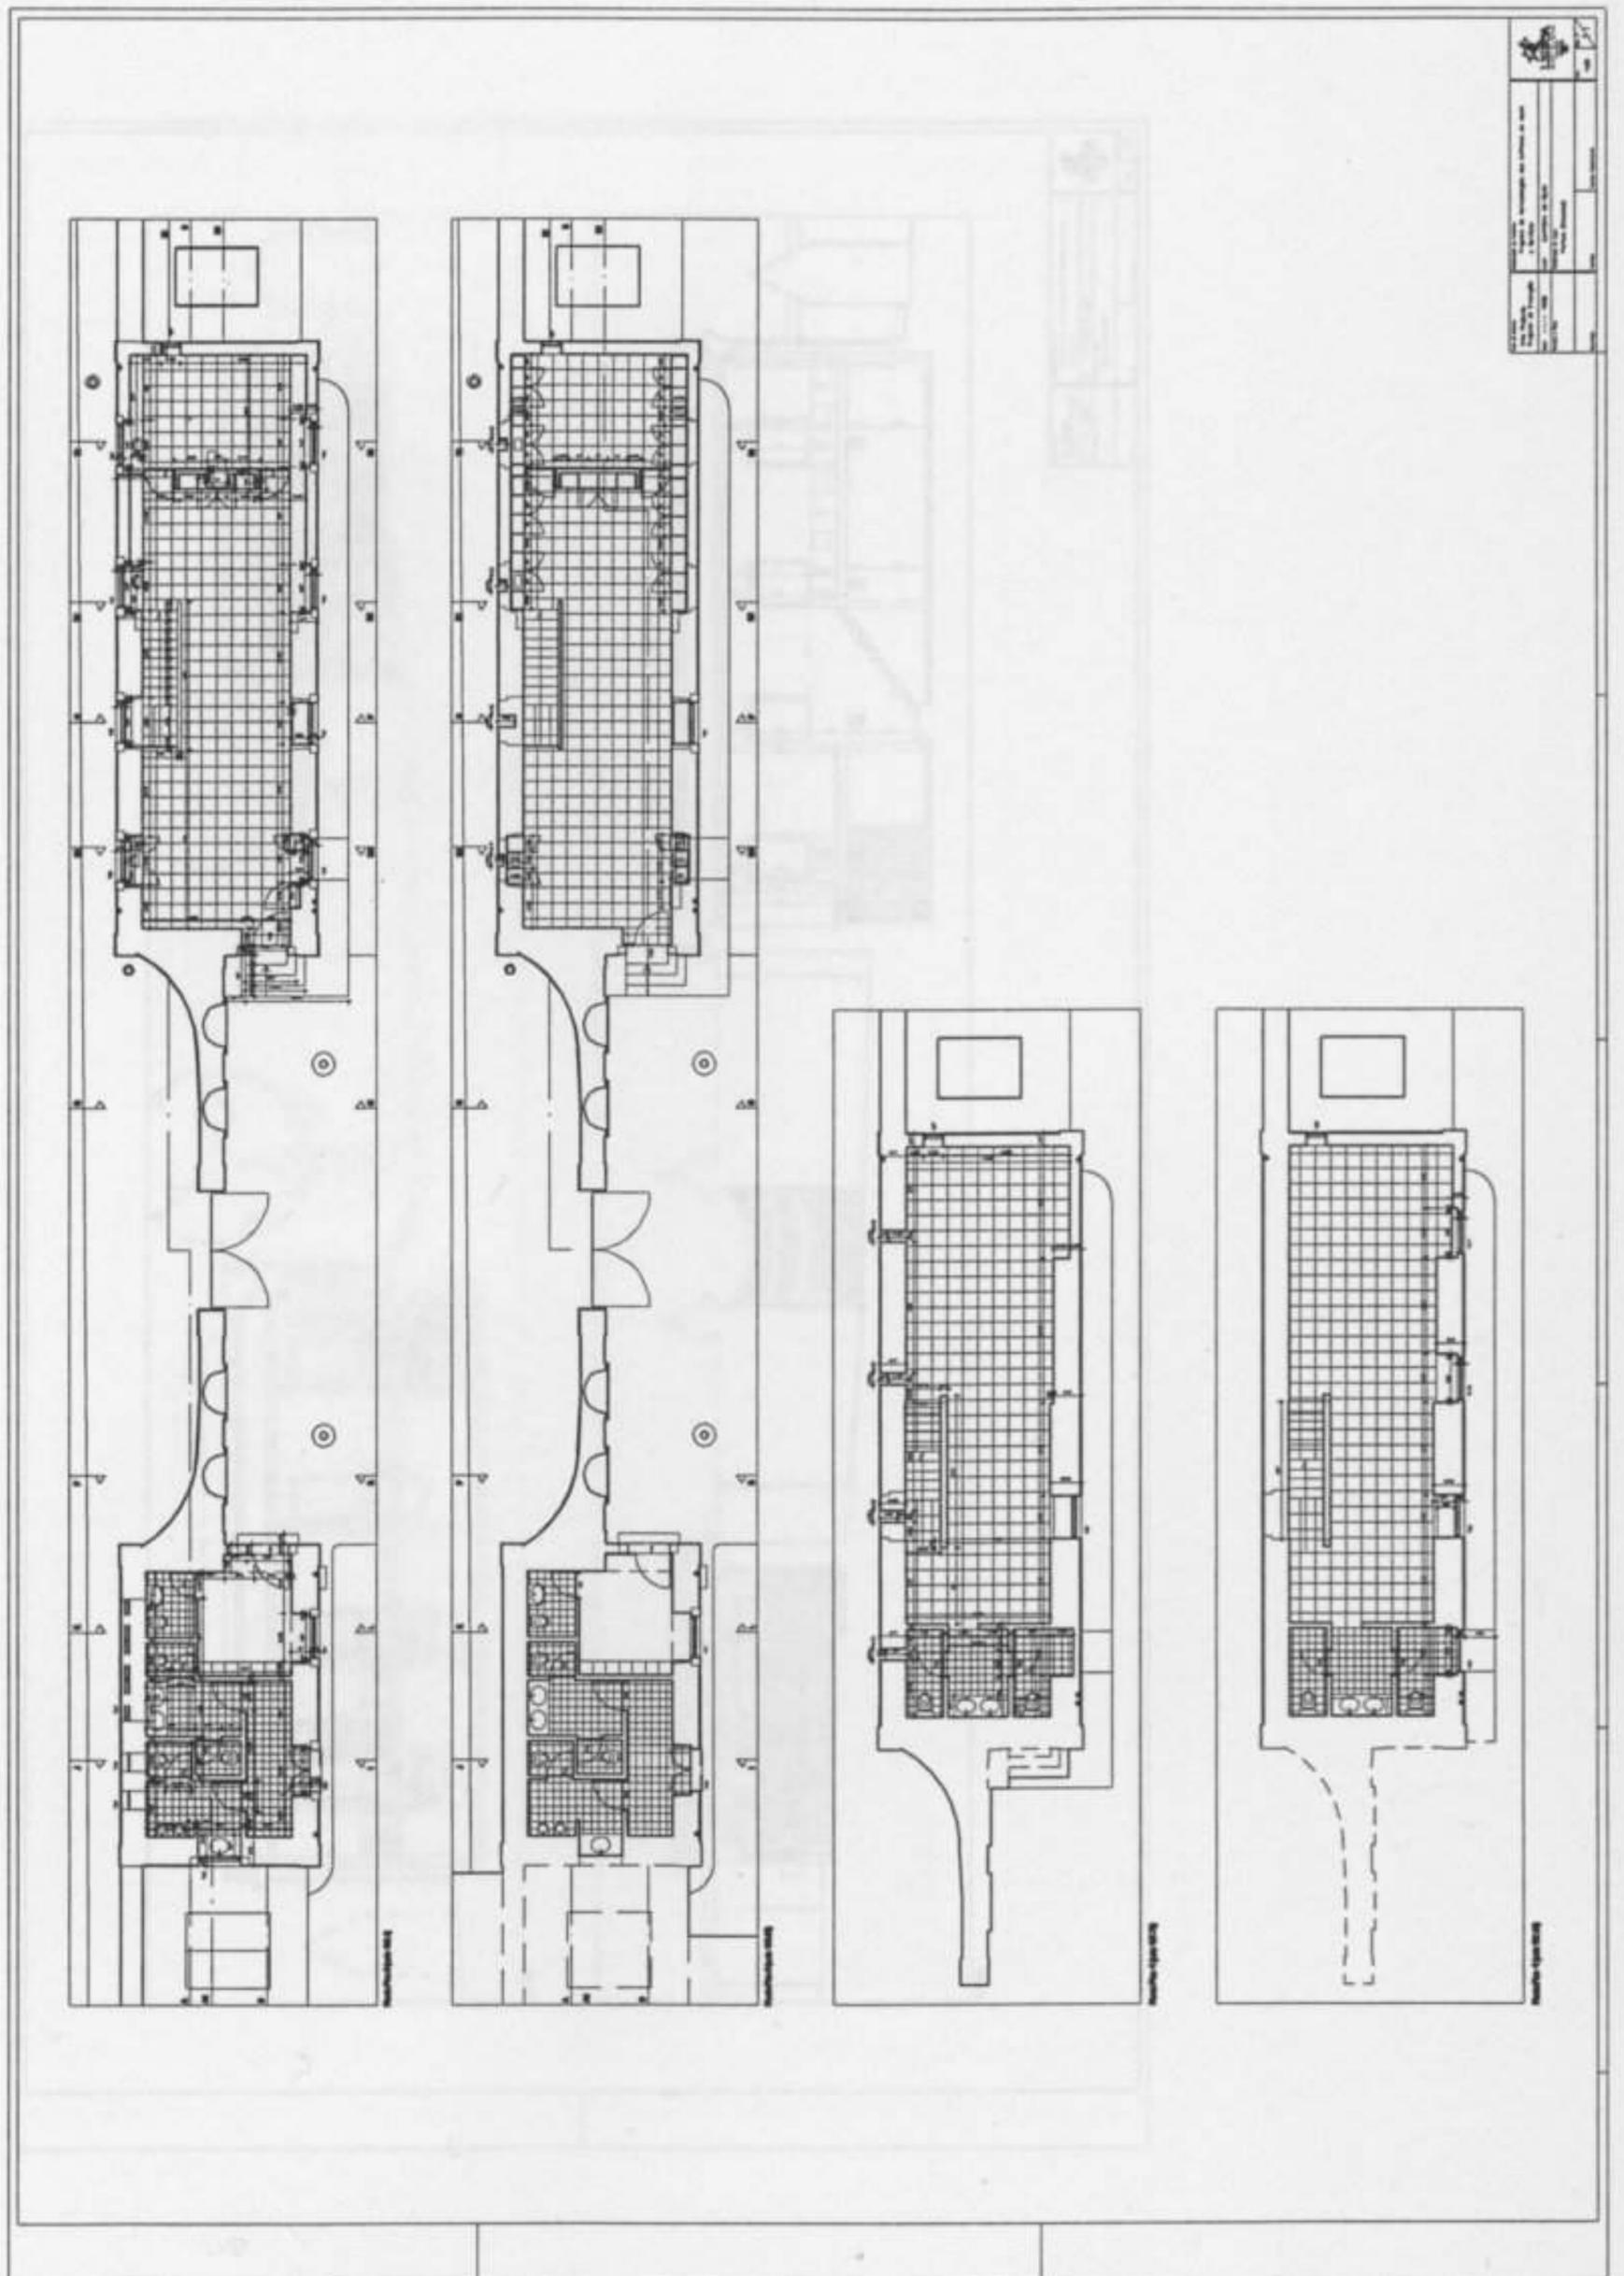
Projecto de Execução - Plantas Cotadas - Esc. 1/50 - Des. nº 15.
